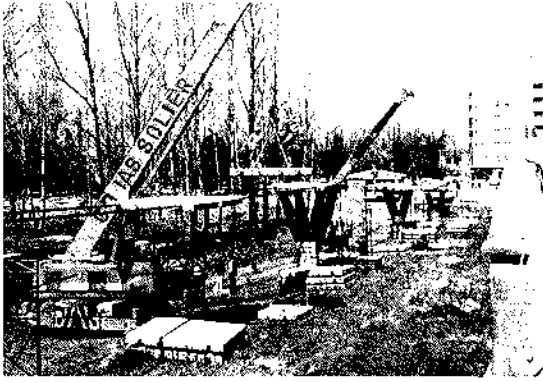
Montaje de fosas prefabricadas sobre los cables.
